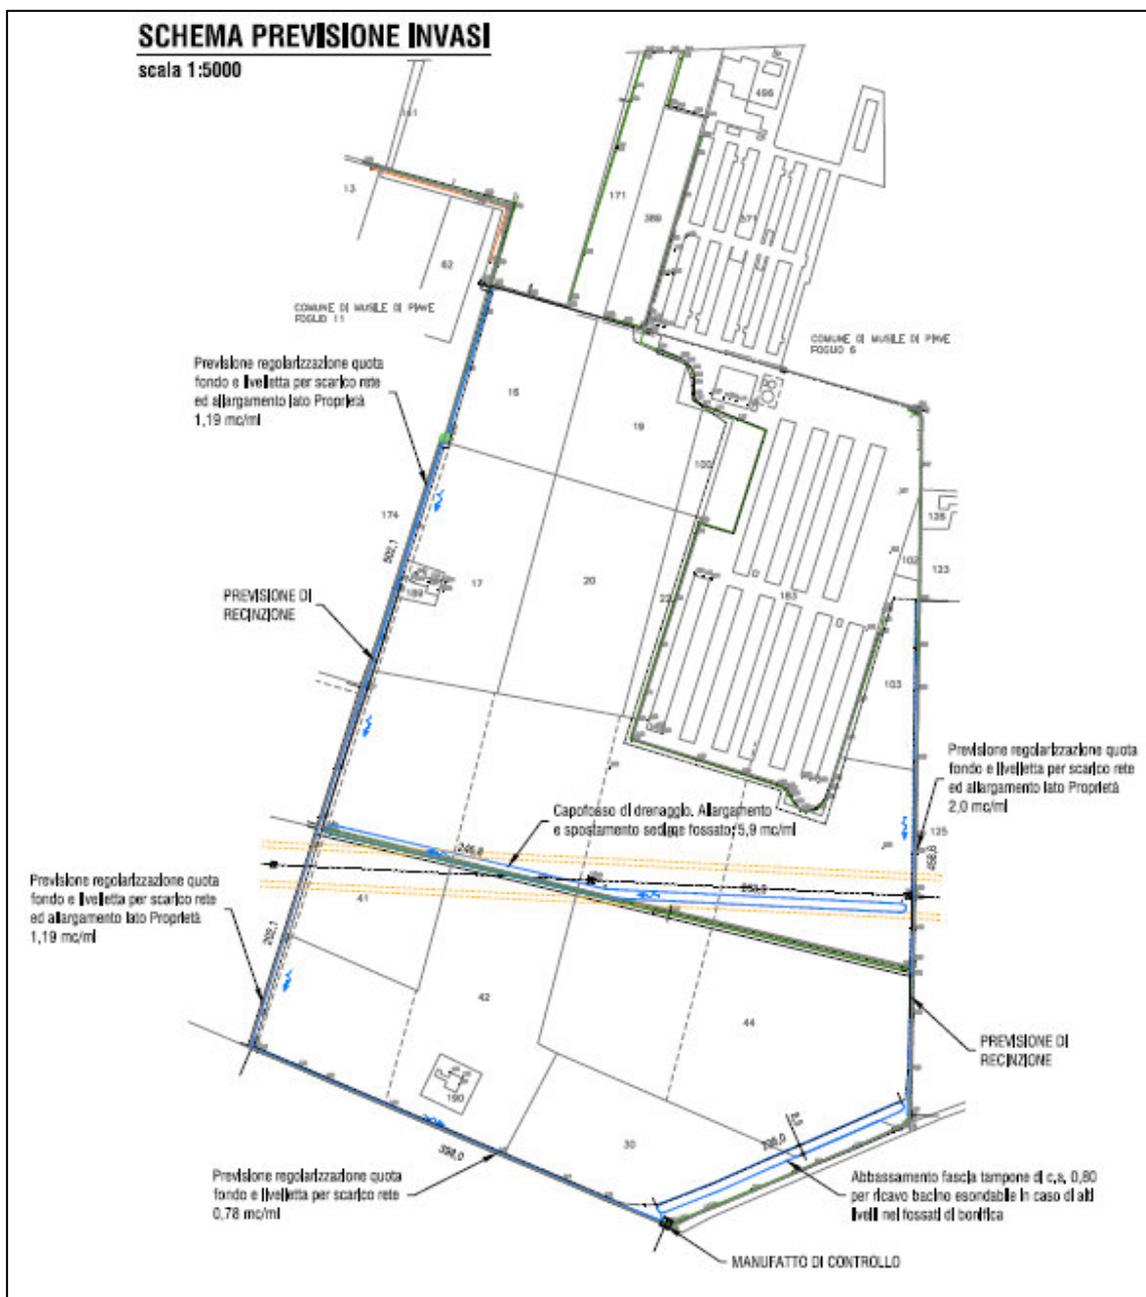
Assetto idraulico di progetto (Fonte: VCI, Elaborato 03_R02)
